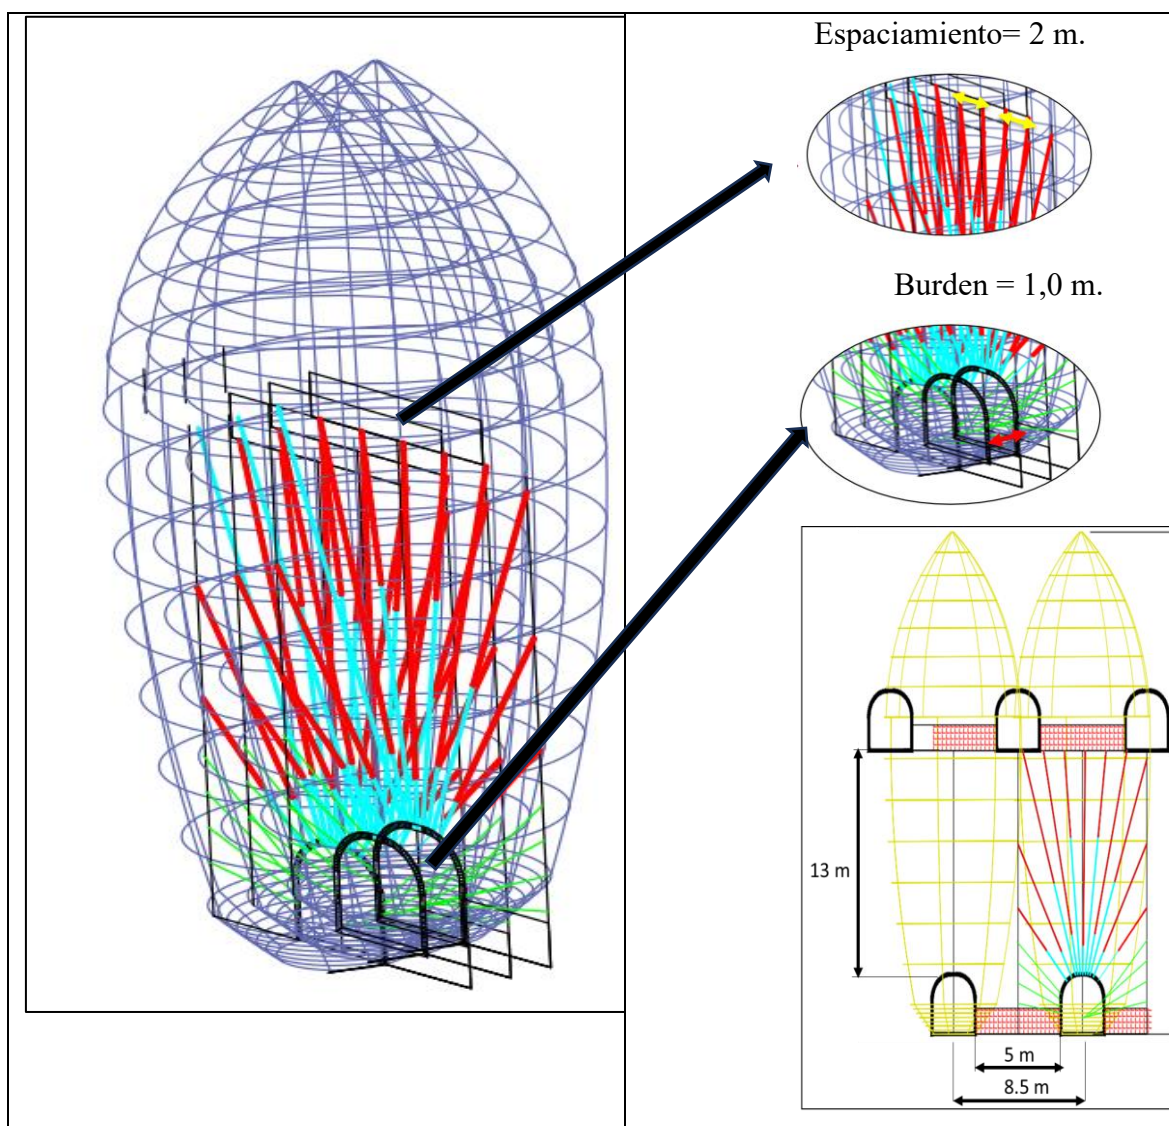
Diseño actual pilar 5 m – altura de block 13 m
